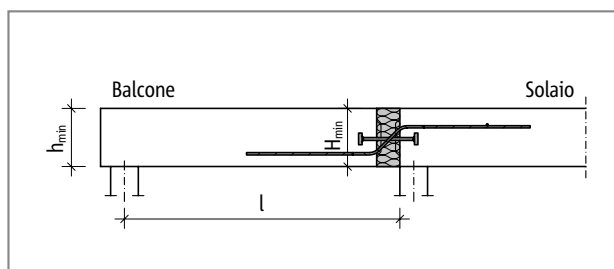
Schöck Isokorb® tipo QP70L – QP80L: schema statico
